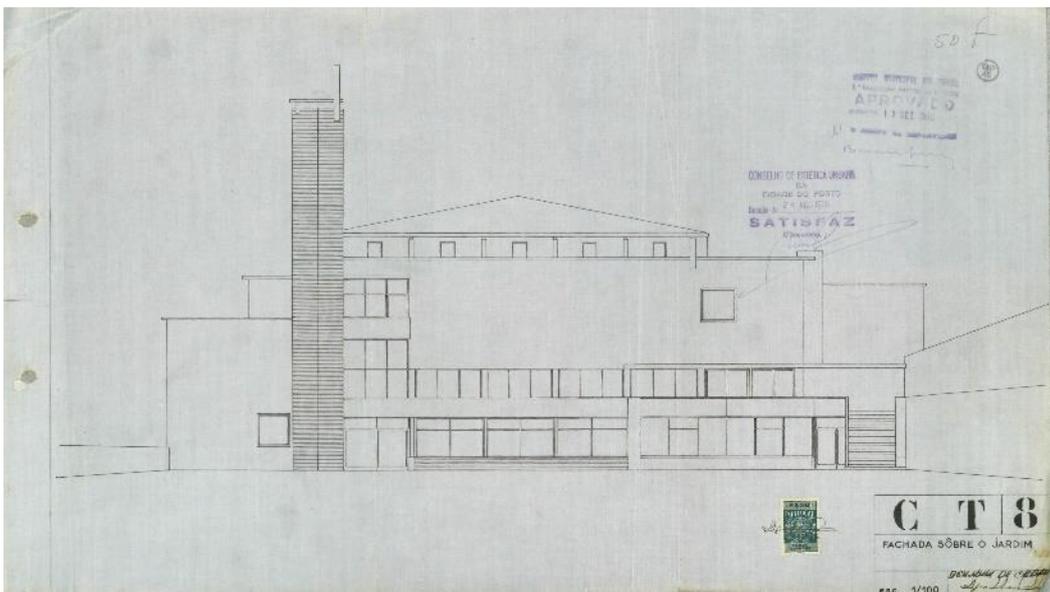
Vista sobre a fachada voltado ao Jardim
